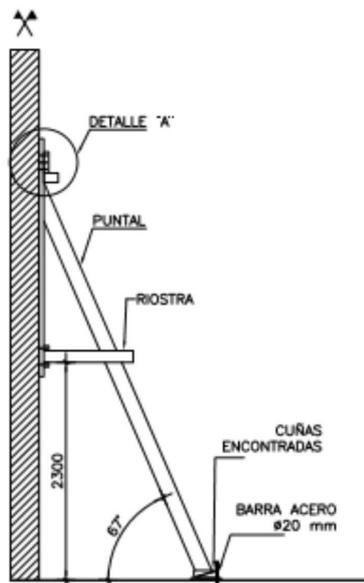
Apuntalamiento de la fachada. Fuente: Proyecto "Panadería Dulcería "Empresa IDEAR de Cienfuegos.
